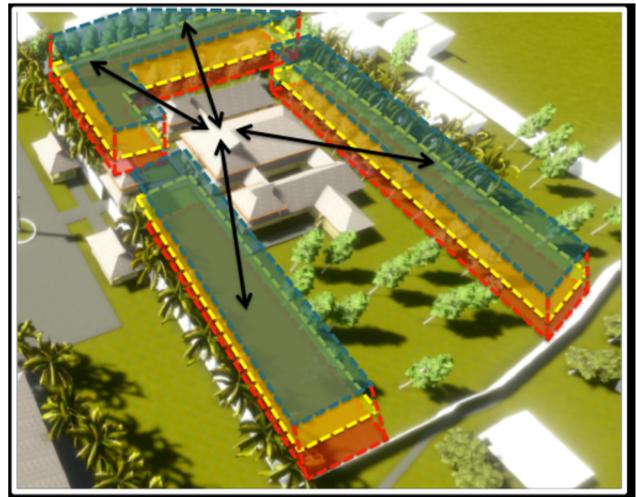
Ruang fungsional yang terbentuk pada fungsi massa bangunan area depan
